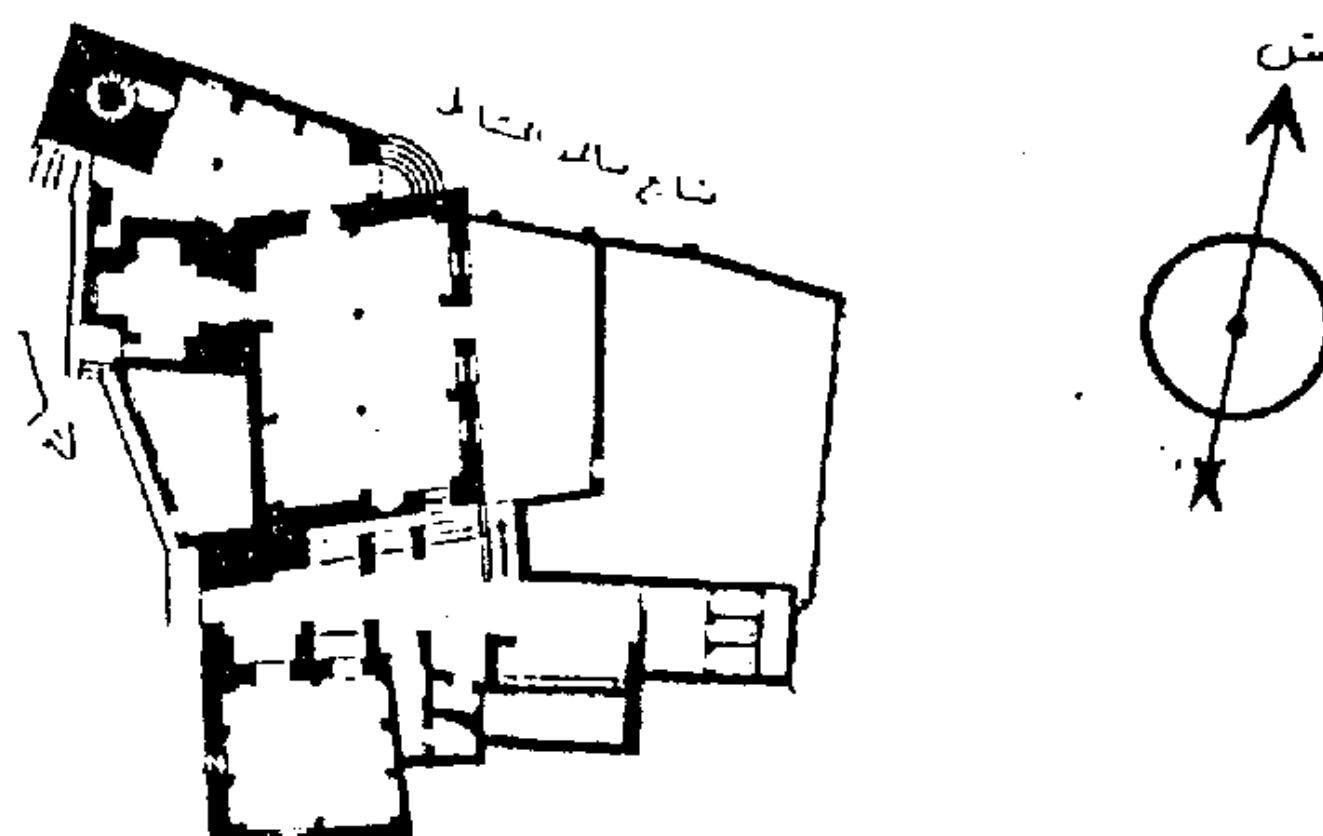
مسقط أفقي لمسجد ميافارقين عن أصلان آبا.
